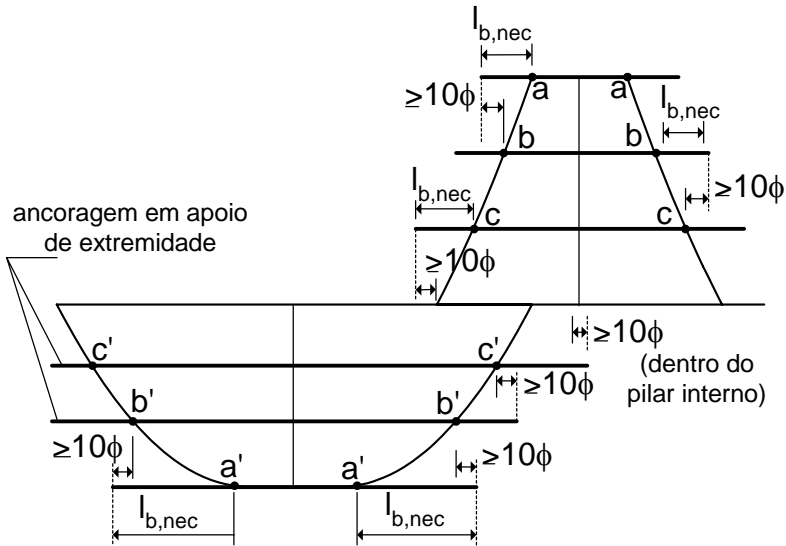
Escalonamento da armadura longitudinal
